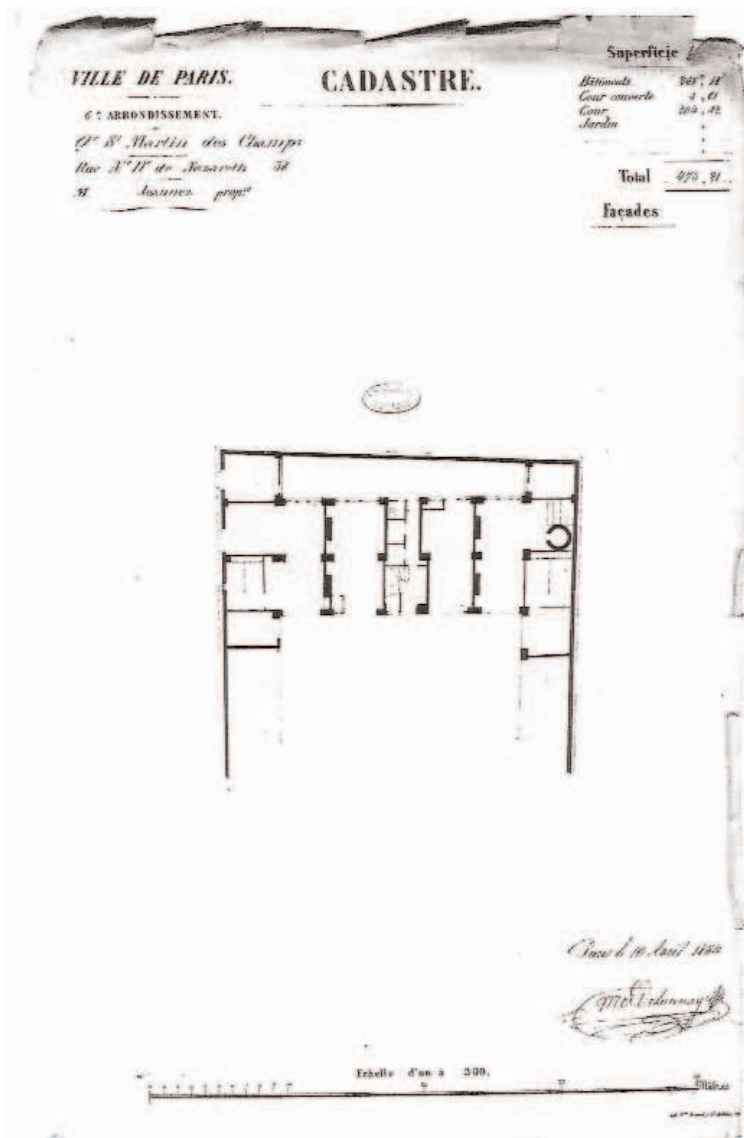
Immeuble construit à l'emplacement de l'ancien atelier démolé en 1853 - Plan cadastral du 10 avril 1854. AN, F³¹ 14, pièce 235.
